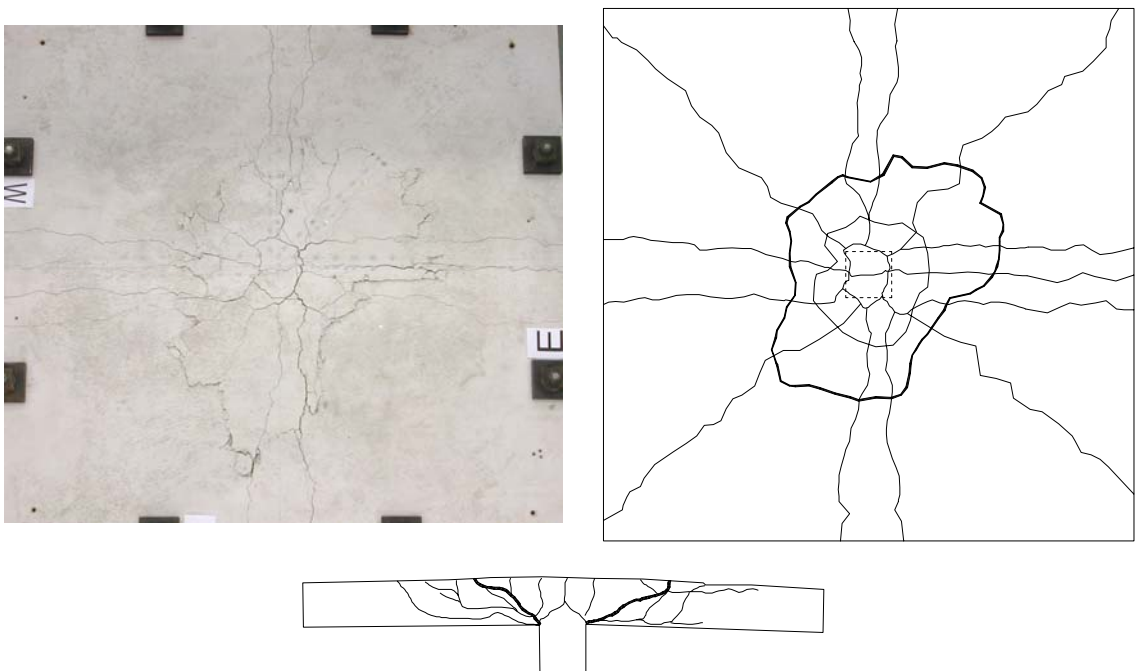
PG-2b : Fissures face supérieure (N en haut) et coupe NS
